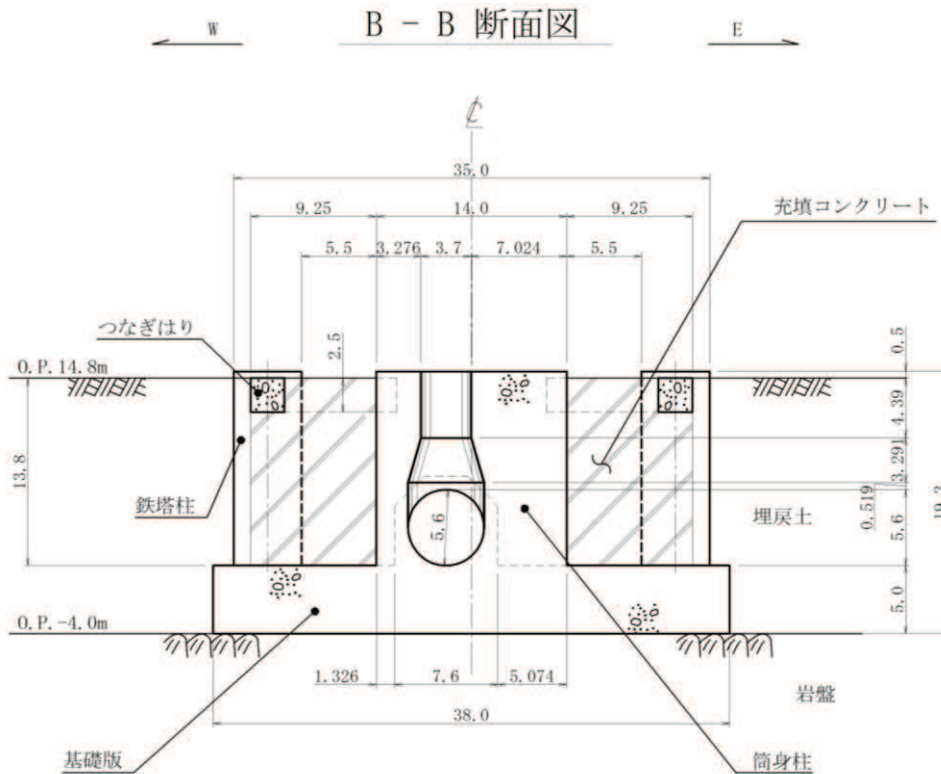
排気筒基礎断面図 (B-B 断面, EW 断面) (単位 : m)
